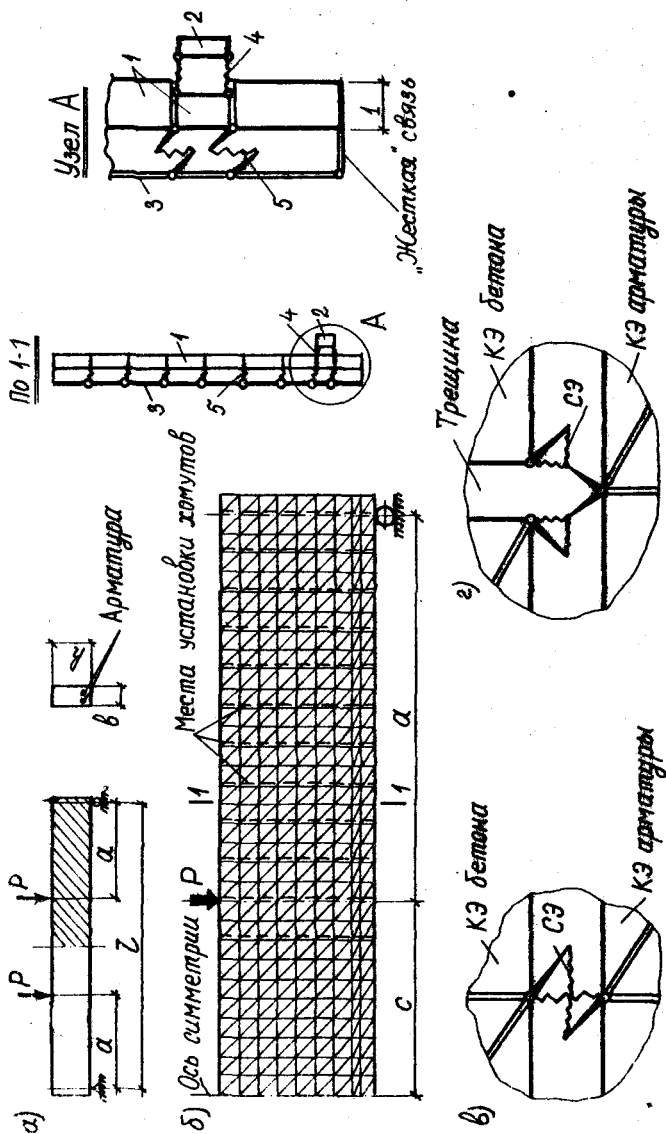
Расчетная схема железобетонной балки: а) - исходная балка; б) - разбивка на конечные элементы (КЭ); в) представление сцепления арматуры с бетоном; г) -то же при пересечении арматуры трещиной; 1 - КЭ бетона; 2 - КЭ продольной арматуры; 3 - линейные КЭ поперечной арматуры; 4,5 - сдвигающий элемент (СЭ)
